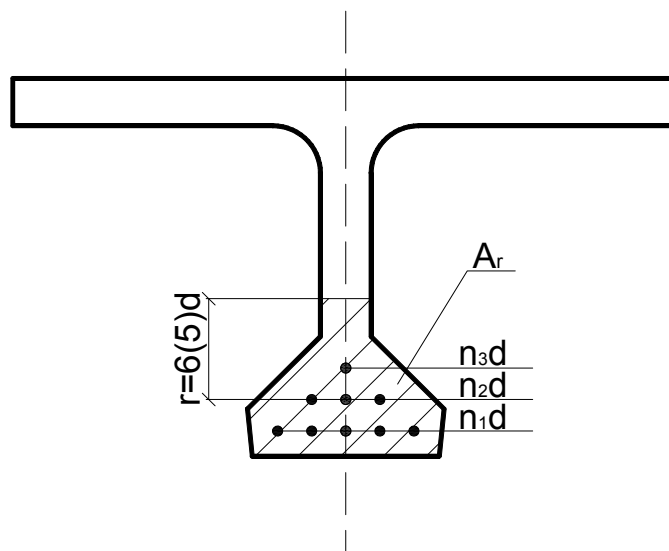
Схема визначення площі взаємодії арматури з бетоном
